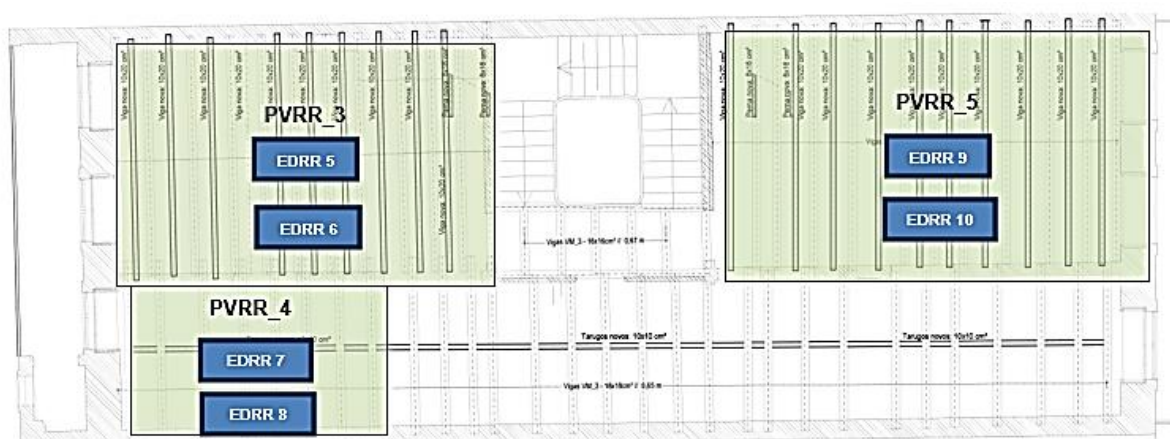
Planta do piso 3, com a identificação esquemática dos pavimentos e ensaios dinâmicos
